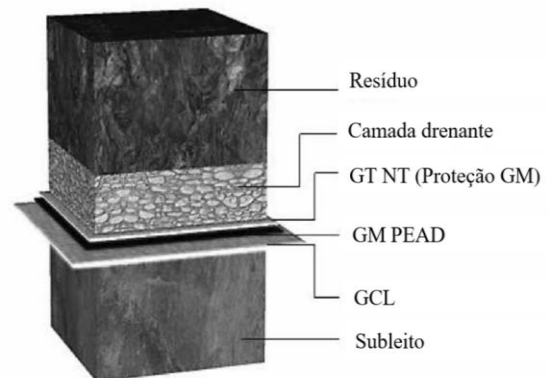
Exemplo de aplicação de GCLs como barreira impermeabilizante de fundo de aterros de resíduos (HEERTEN, 2002 apud PIMENTEL, 2008).
